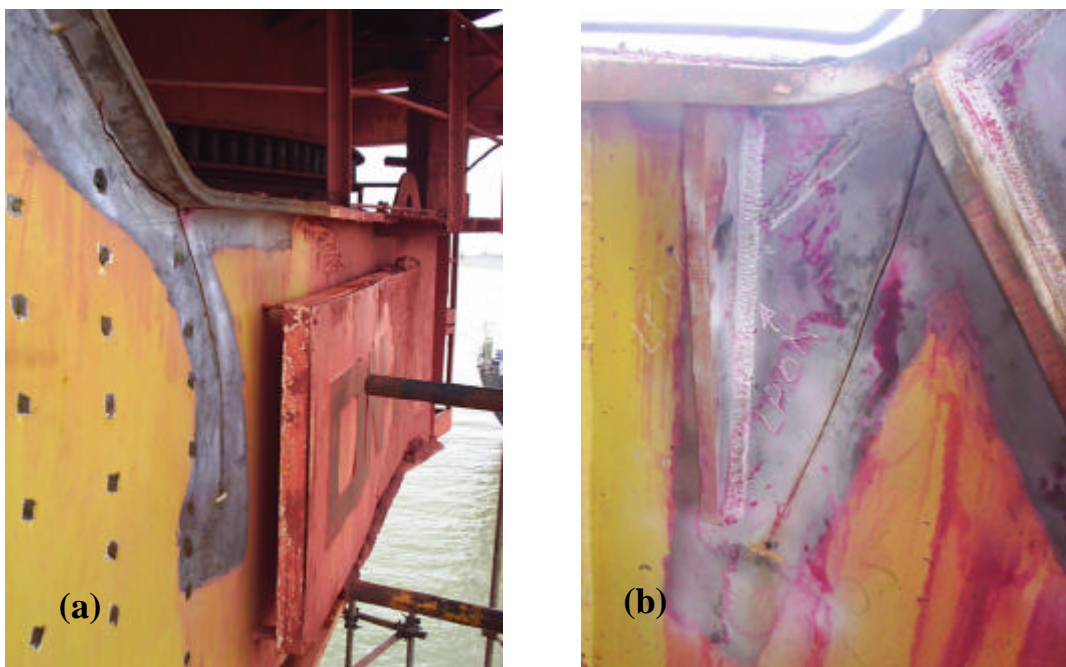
(a) Trinca na alma da “face externa” da viga do lado direito da estrutura de suporte.
